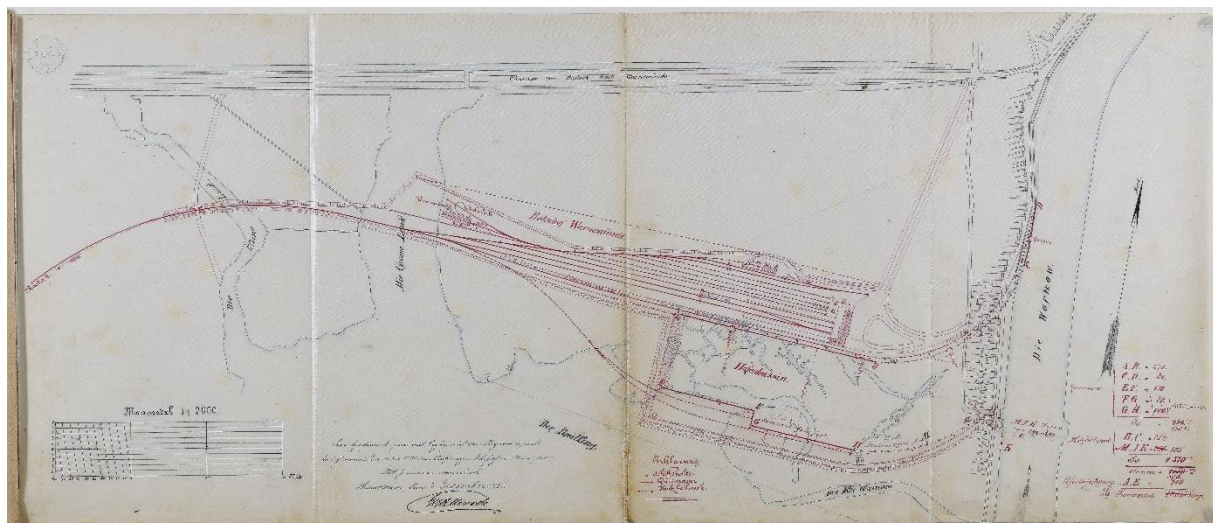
Lageplan der Hafen- und Bahnbauten 1884
